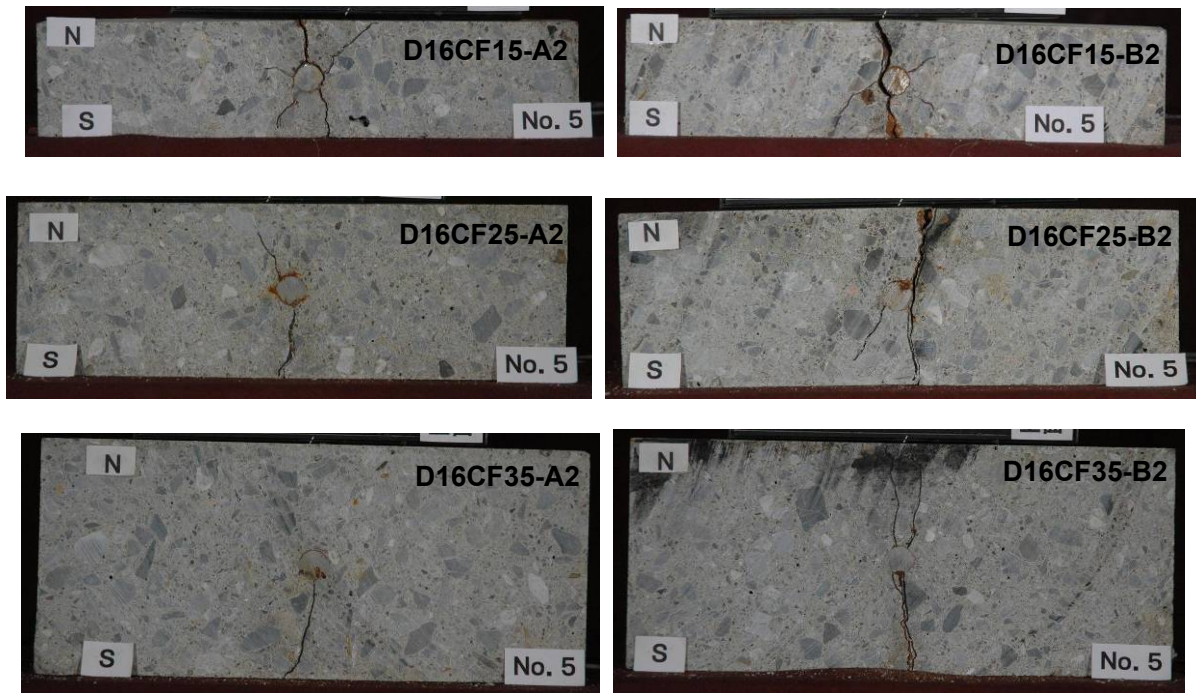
各試験体の腐食ひび割れ状況
